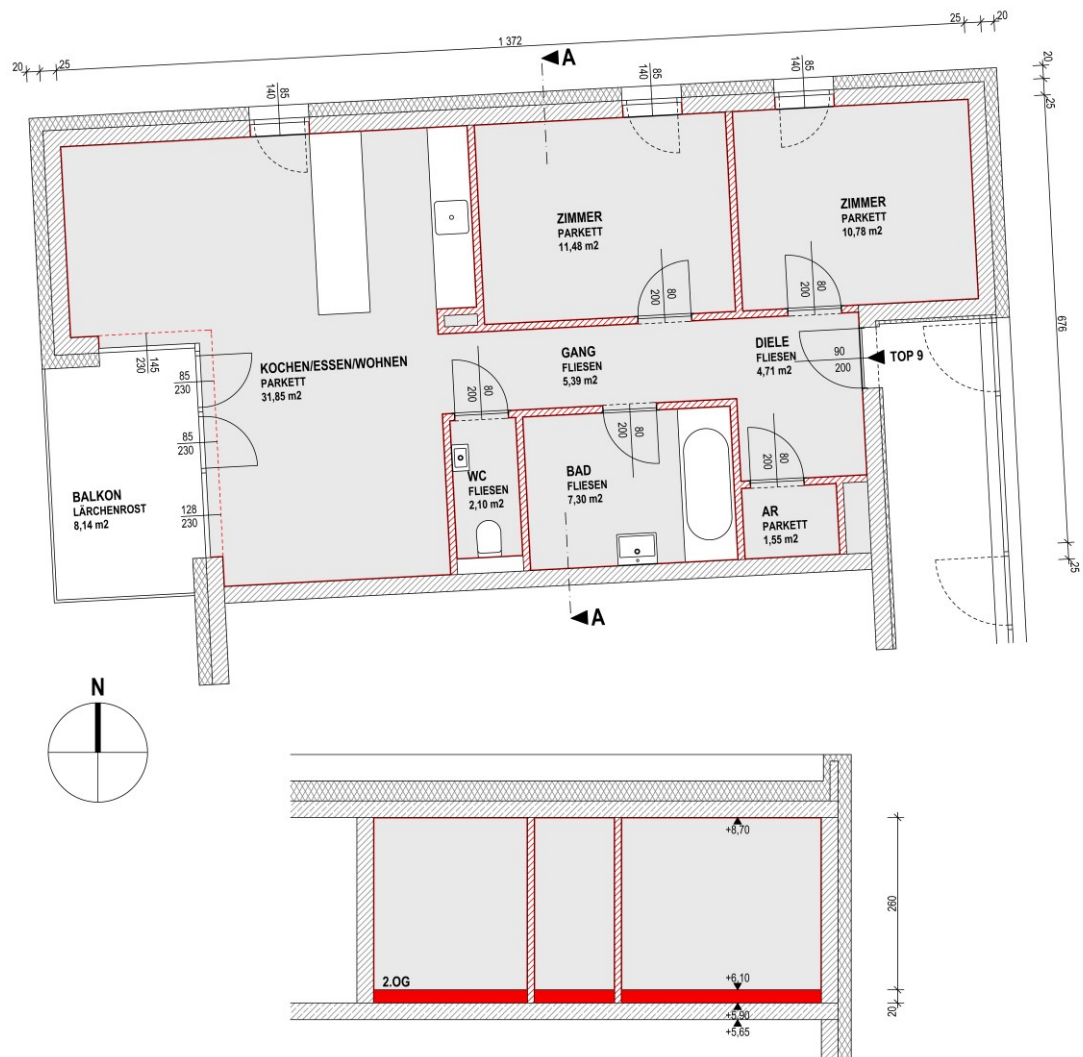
Grundrissdarstellung des Modellgebäudes (eigene Darstellung)
